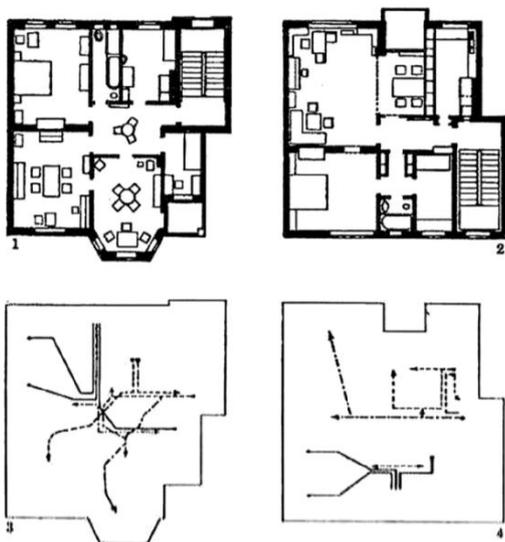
Comparación entre una planta tradicional mal distribuida y una planta moderna bien distribuida, con esquemas de circulaciones interiores. Ponencia de 1928, Alexander Klein.
